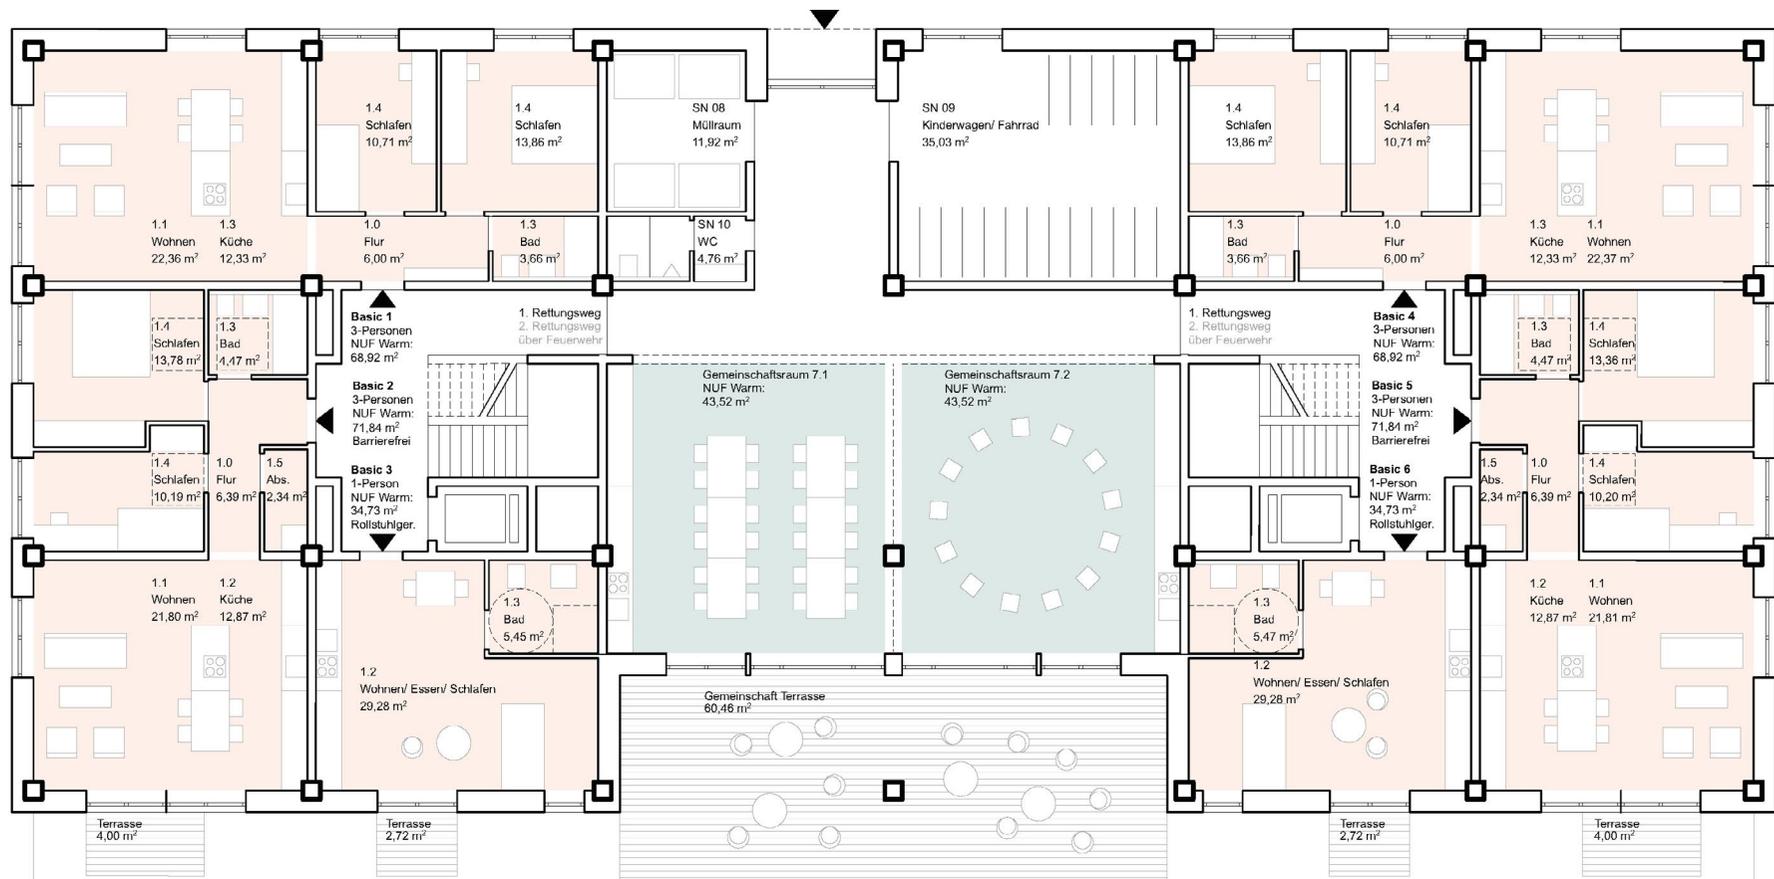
Erdgeschoss | M 1:175 | SoerenHoeller Architektur (Hamburg)
